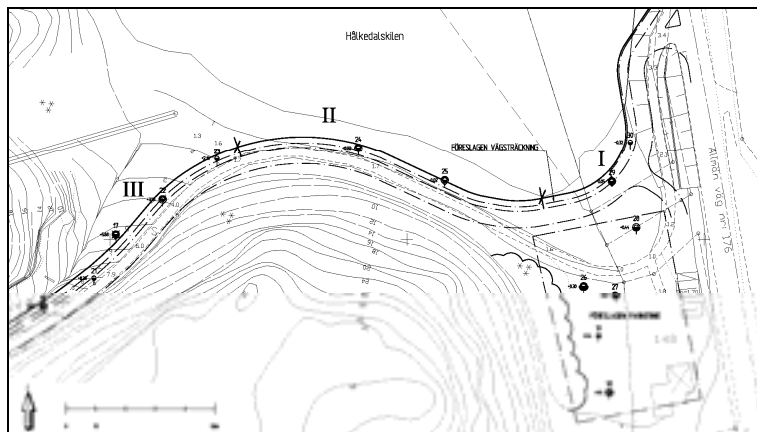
Undersökta delsträckor utmed infartsvägen. I planbeskrivningen för Hälledalen 1:2 m fl beskrivs endast sträcka II och III. Sträcka I ingår i planområdet för den planerade småbåtshamnen i Hälledalen och beskrivs närmare i planbeskrivningen till den detaljplanen.
